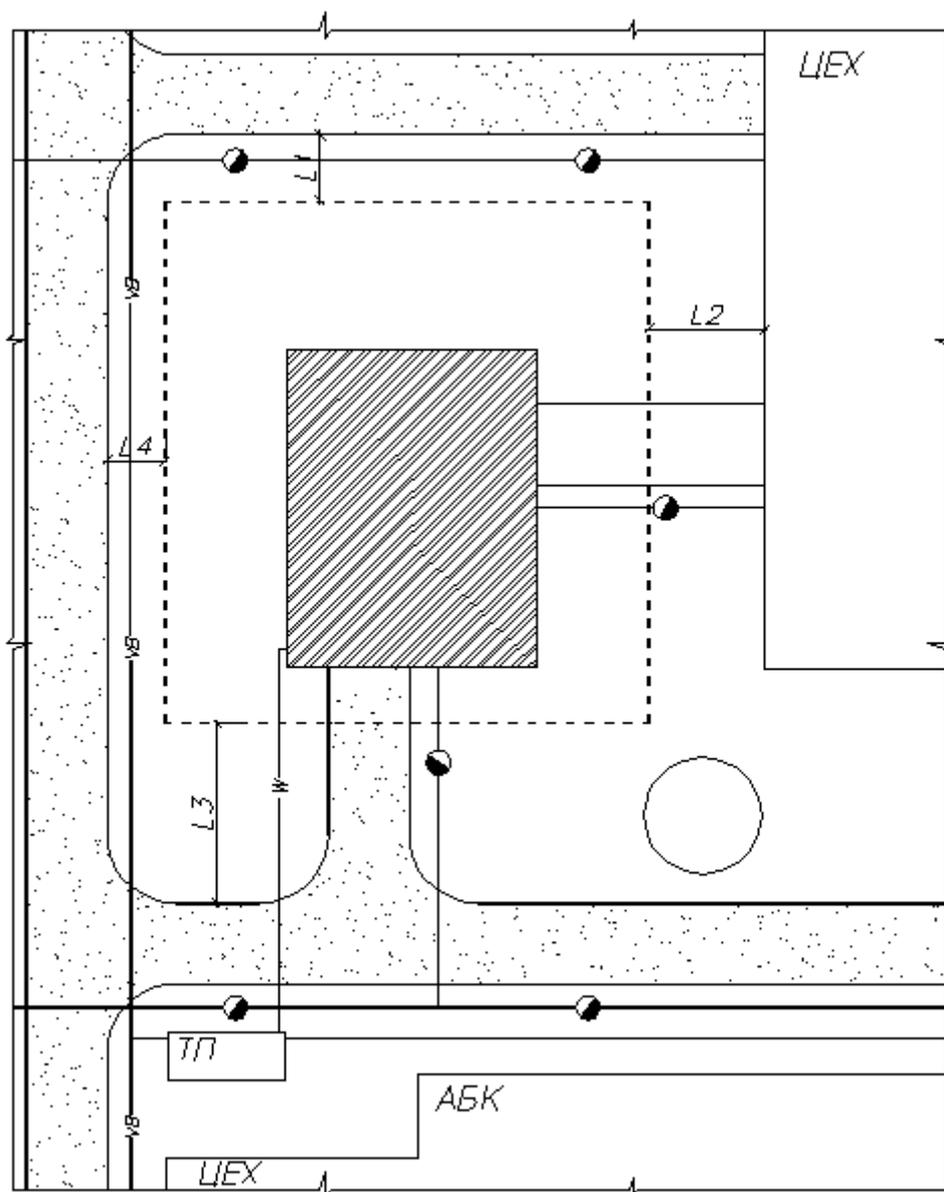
Схема Генплана многоэтажного здания (вариант 1)
